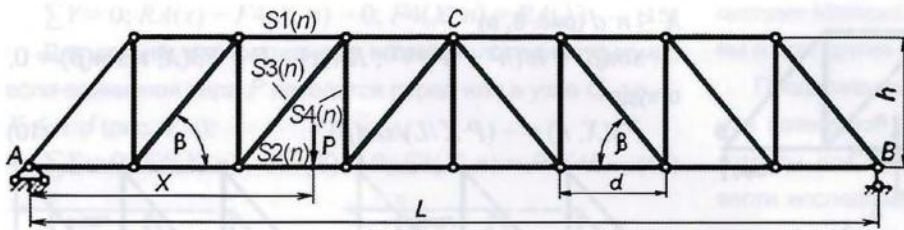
Схема трапециевидальной балочной фермы мостового крана
